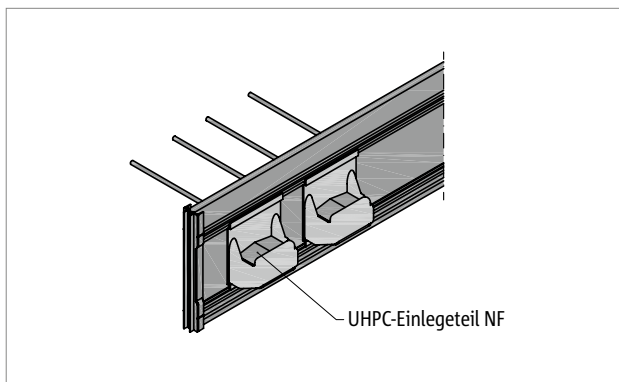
Schöck Tronsole® Typ T : Detail Tragkonsole negative Fertigung
